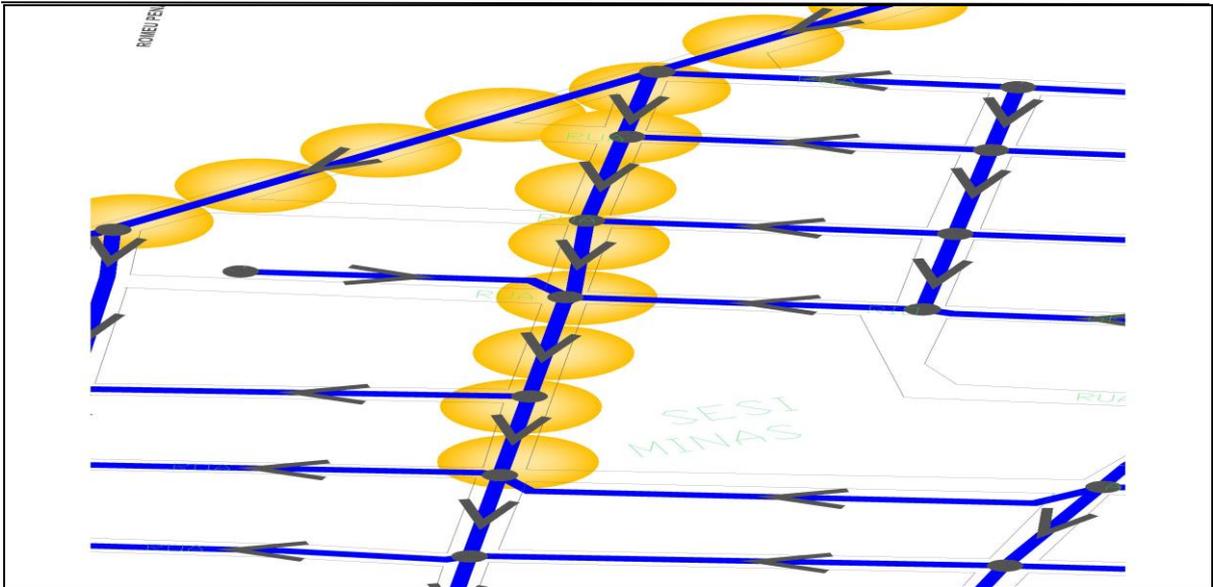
Pontos de extravasamento no Bairro Boa Vista
